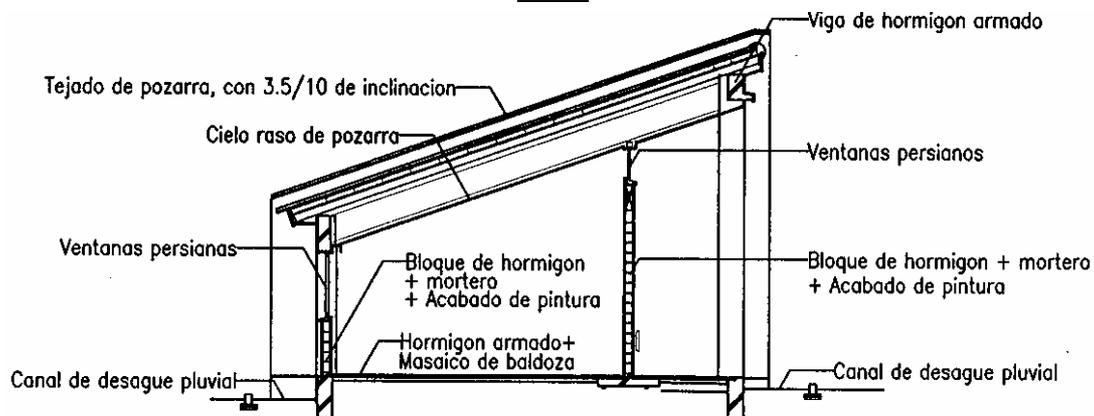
Diseño del plan de perfil transversal para las CLIPERs (de Villanueva, de Choloma)
